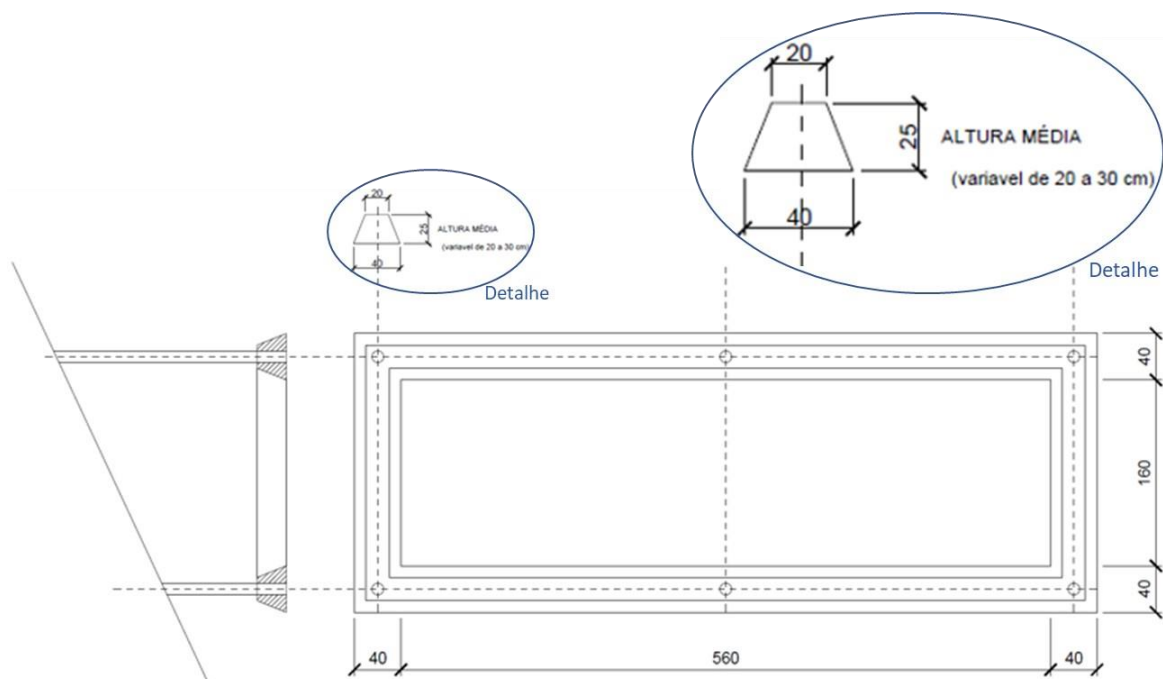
Fundação de concreto armado em formato de anel proposta para sustentação dos módulos FV nausina do Aterro Sanitário de Santa Cruz.
